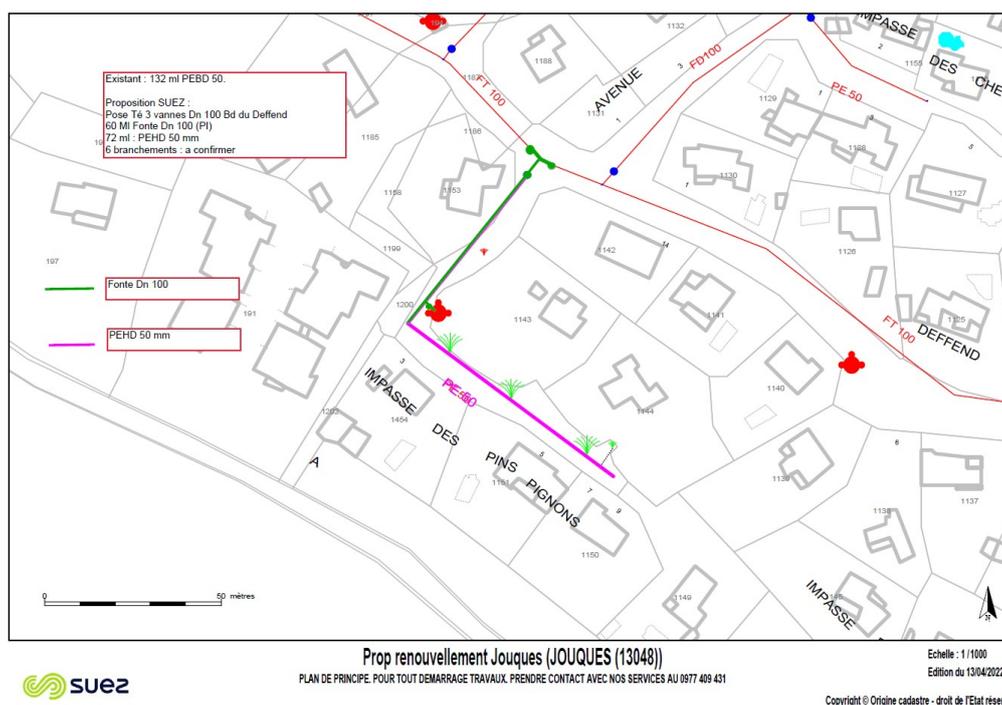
Plan d'une proposition de renouvellement d'un tronçon
